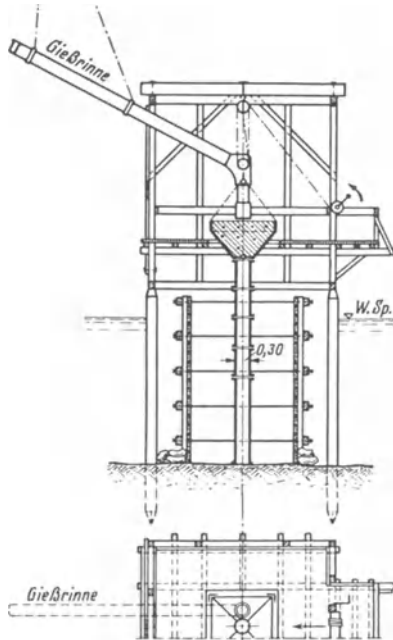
Durchführung von Unterwasserbeton nach dem Kontraktorverfahren.
